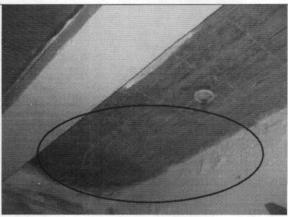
Desprendimiento parcial de cielo raso bajo cubierta
